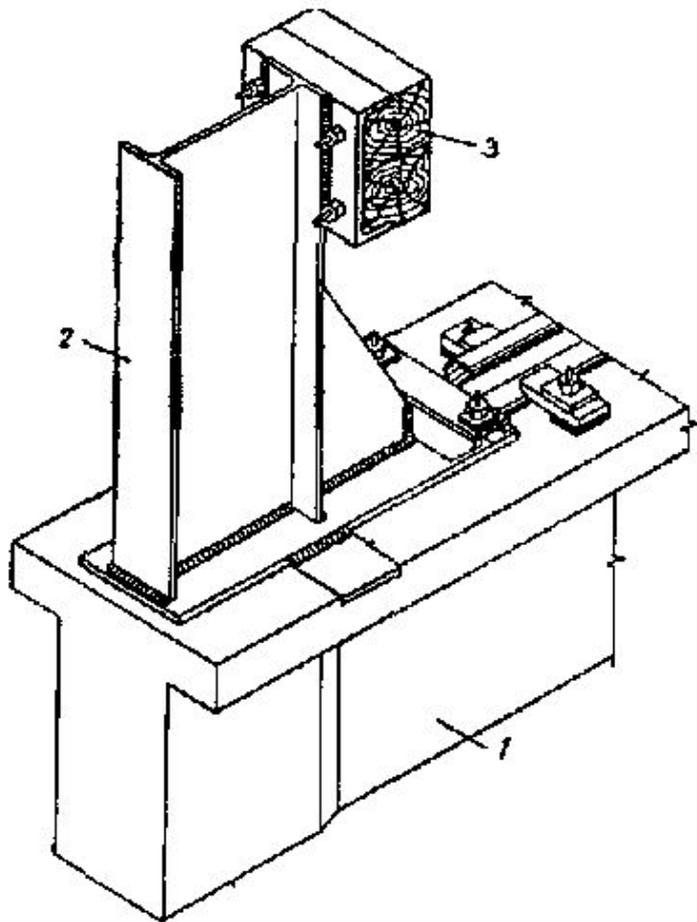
Крановый упор на подкрановой балке. 1 — подкрановая балка
